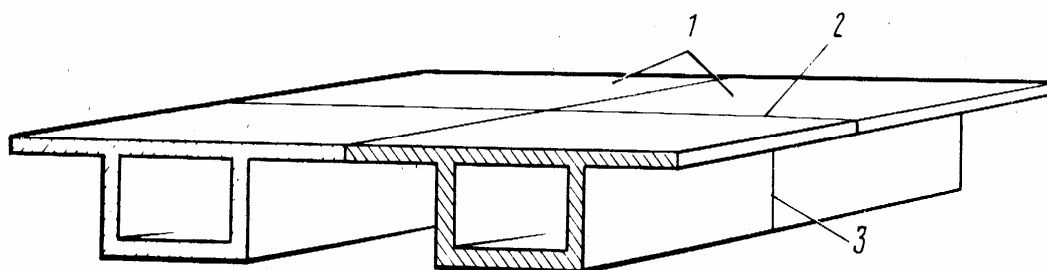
Коробчатая балка с продольным и поперечным членением на монтажные блоки
